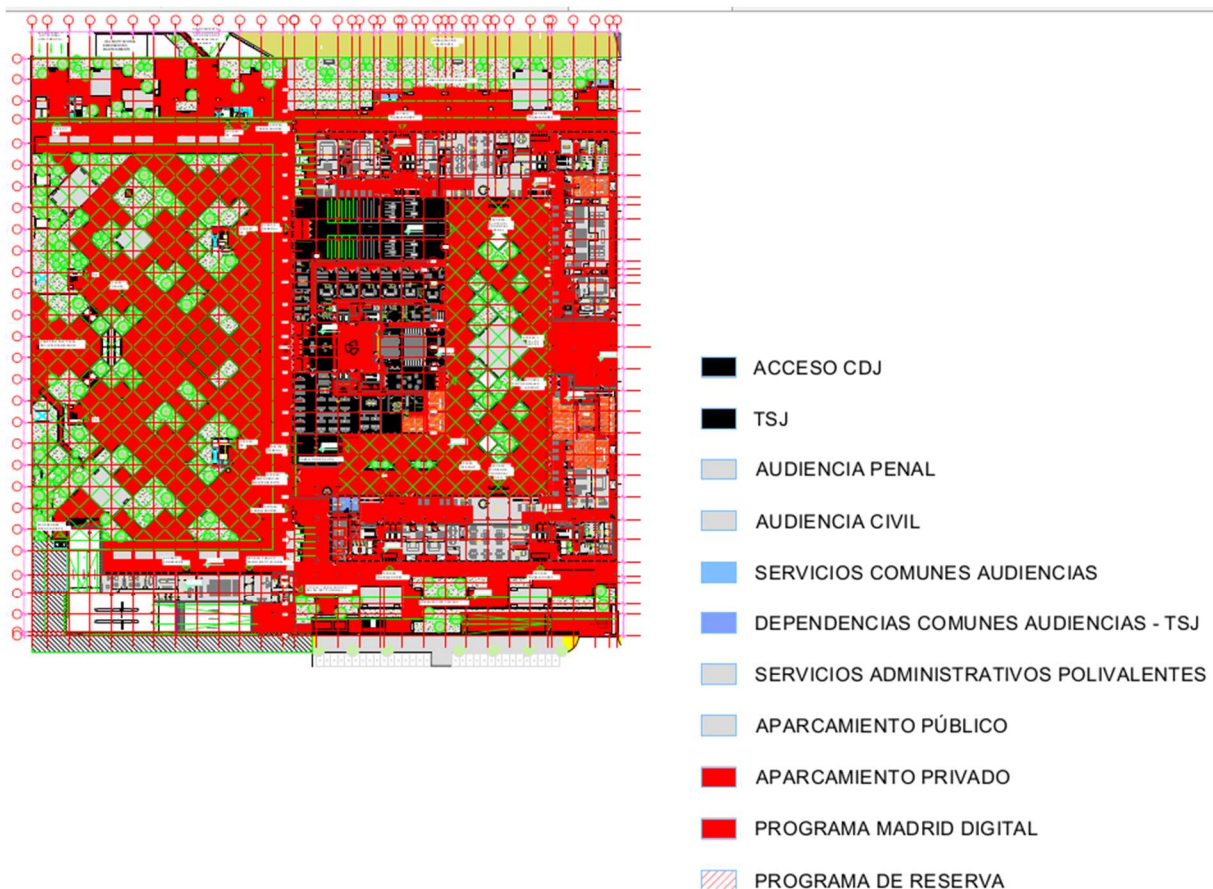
Plano arquitectónico de la superficie a drenar (planta baja). Fuente: Proyecto constructivo de la Ciudad de la Justicia.
